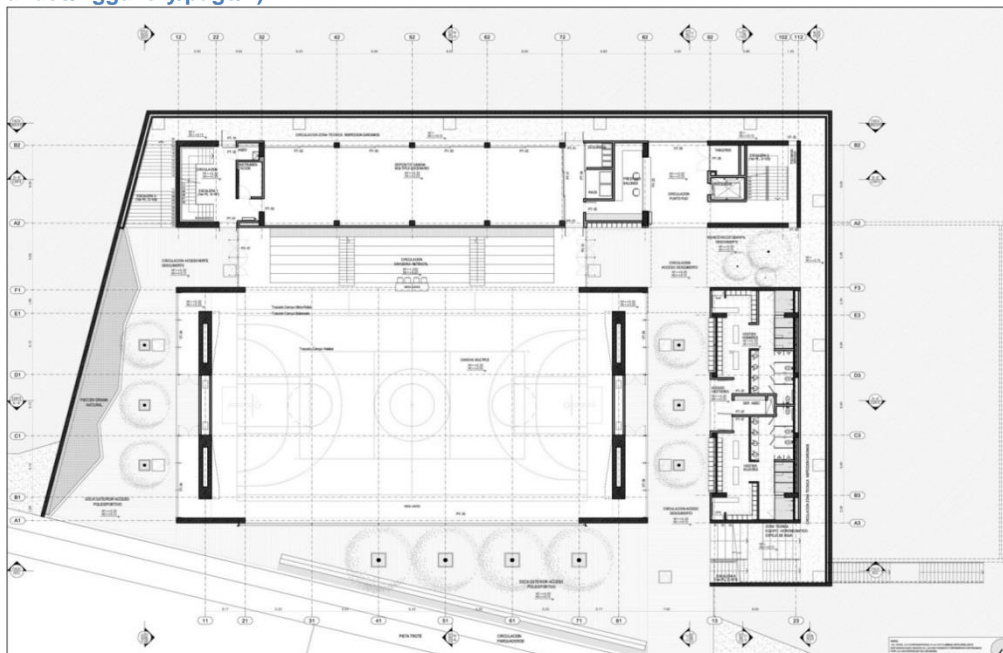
Planta arquitectónica general, (fuente: <https://www.arquitecturapanamericana.com/centro-deportivo-universidad-de-los-andes/nggallery/page/1>).
